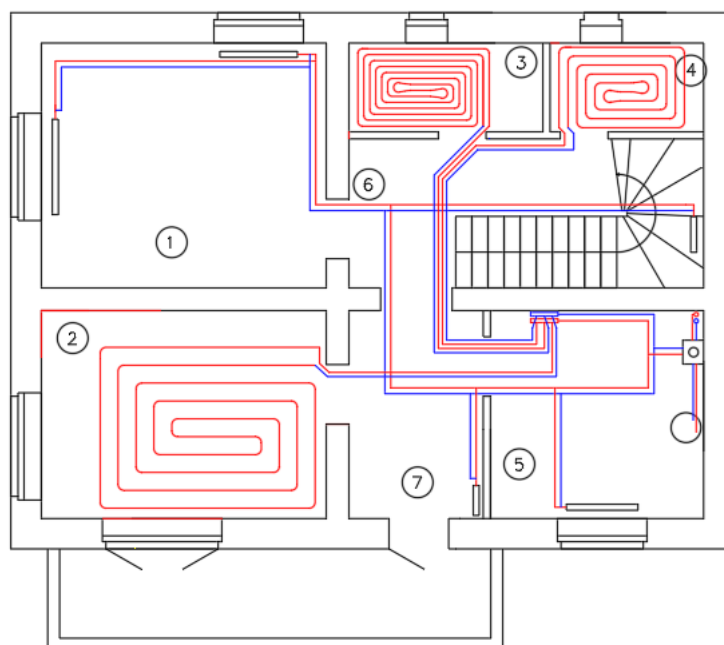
План первого этажа дома с нанесением элементов системы отопления
